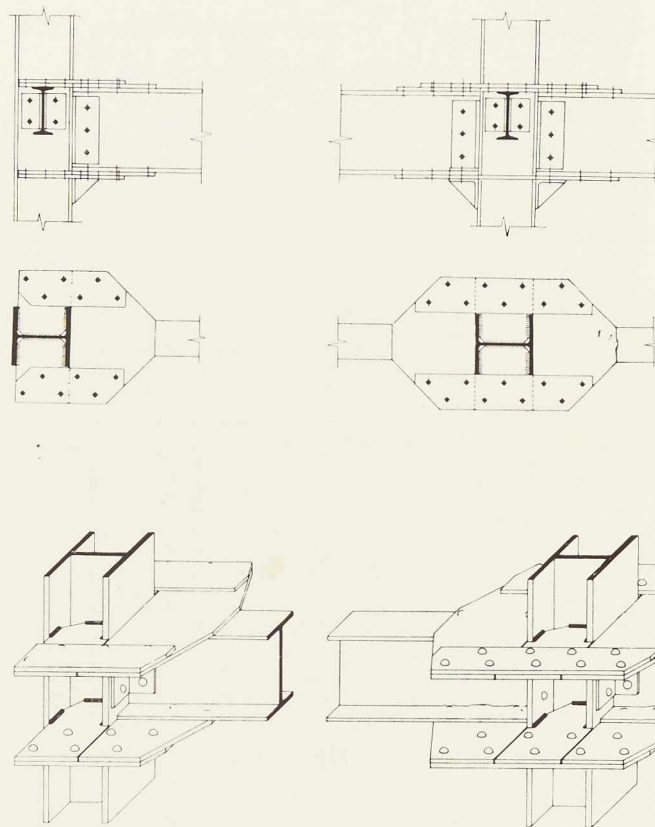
Détails constructifs des assemblages du portique : assemblage d'extrémité, assemblage intermédiaire. Ces assemblages, dits à goussets horizontaux assurent la transmission des moments entre la poutre et la colonne.
